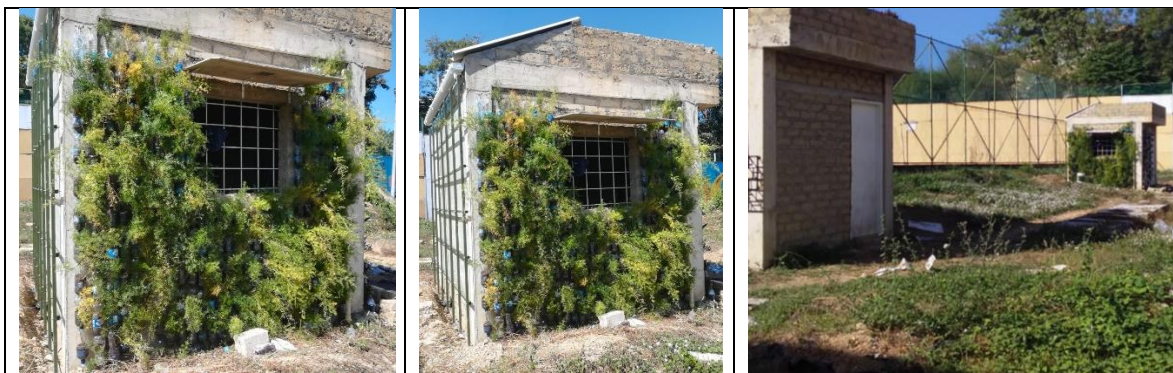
Muro verde con Espárrago, ubicado en la fachada Este.
